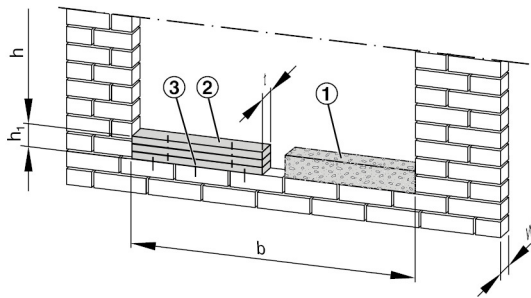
Einbauöffnung mit Auffütterung zur Höhenanpassung
